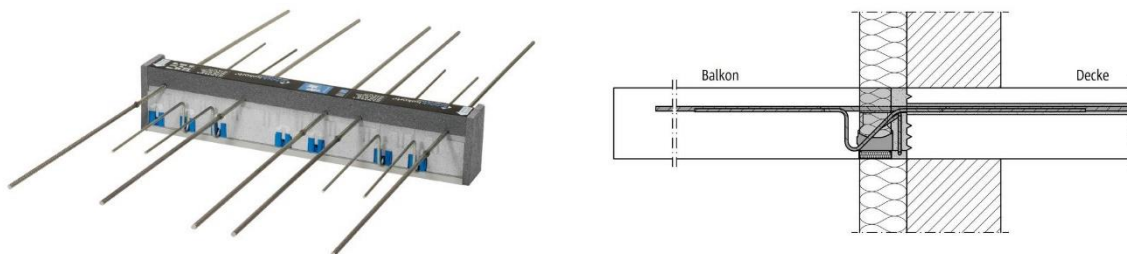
Exemplarische Darstellung Schöck Isokorb KXT mit 120 mm Dämmstärke (Beton/Beton-Konstruktionen. Schöck Isokorb OR 120 mm. 2016)
